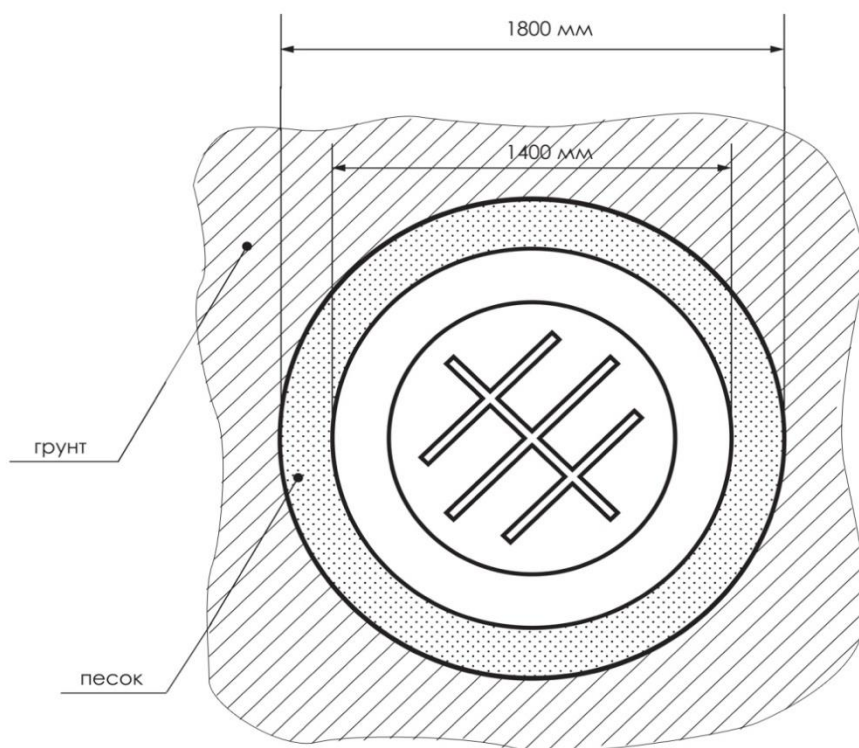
Обозначение габаритных размеров станции СБО «АК-4-7» в разрезе (вид сверху).
